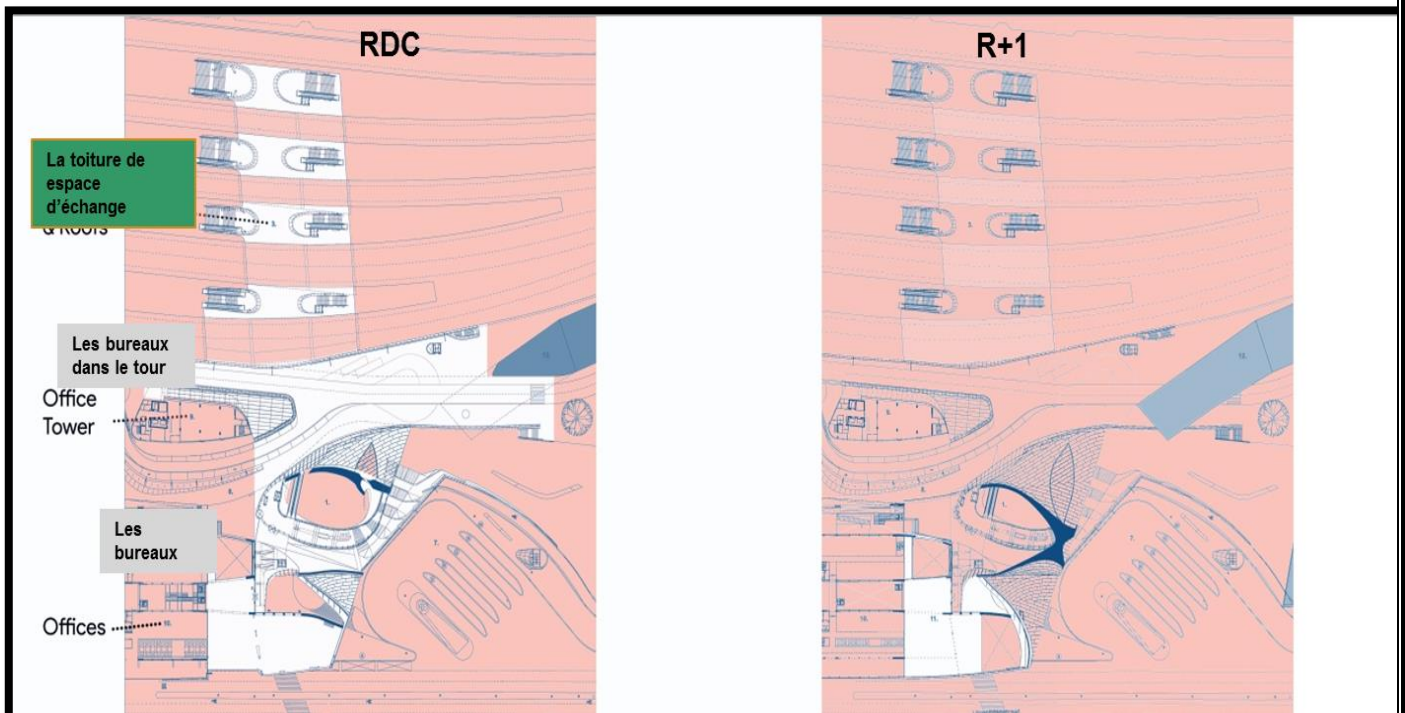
plan RDC et R+1 de projet Terminal de transfert central d'Arnhem
